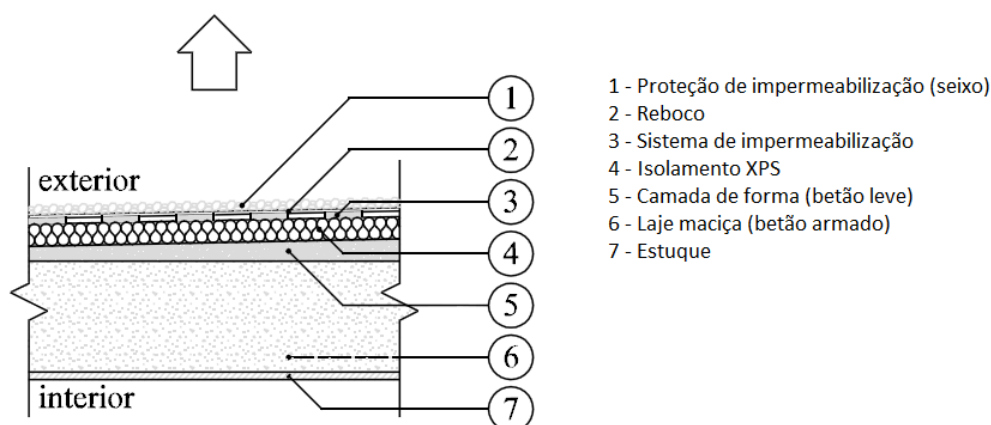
Solução construtiva da cobertura exterior em terraço.
